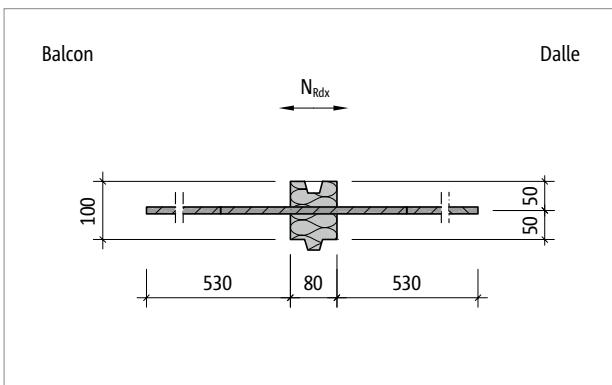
Schöck Isokorb® T Type H-NN2 : Plan de base du produit
